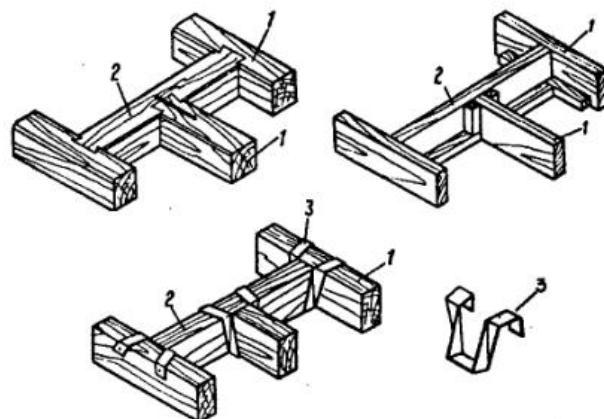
Крепление ригеля к балкам перекрытия: 1 — балка перекрытия; 2 — ригель; 3 — металлический хомут.
